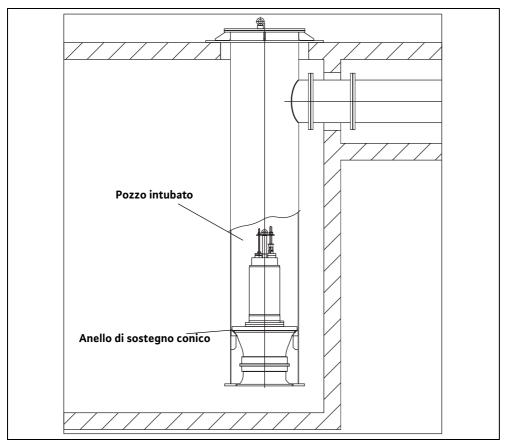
Montaggio in tubo con uscita sotto il pavimento
